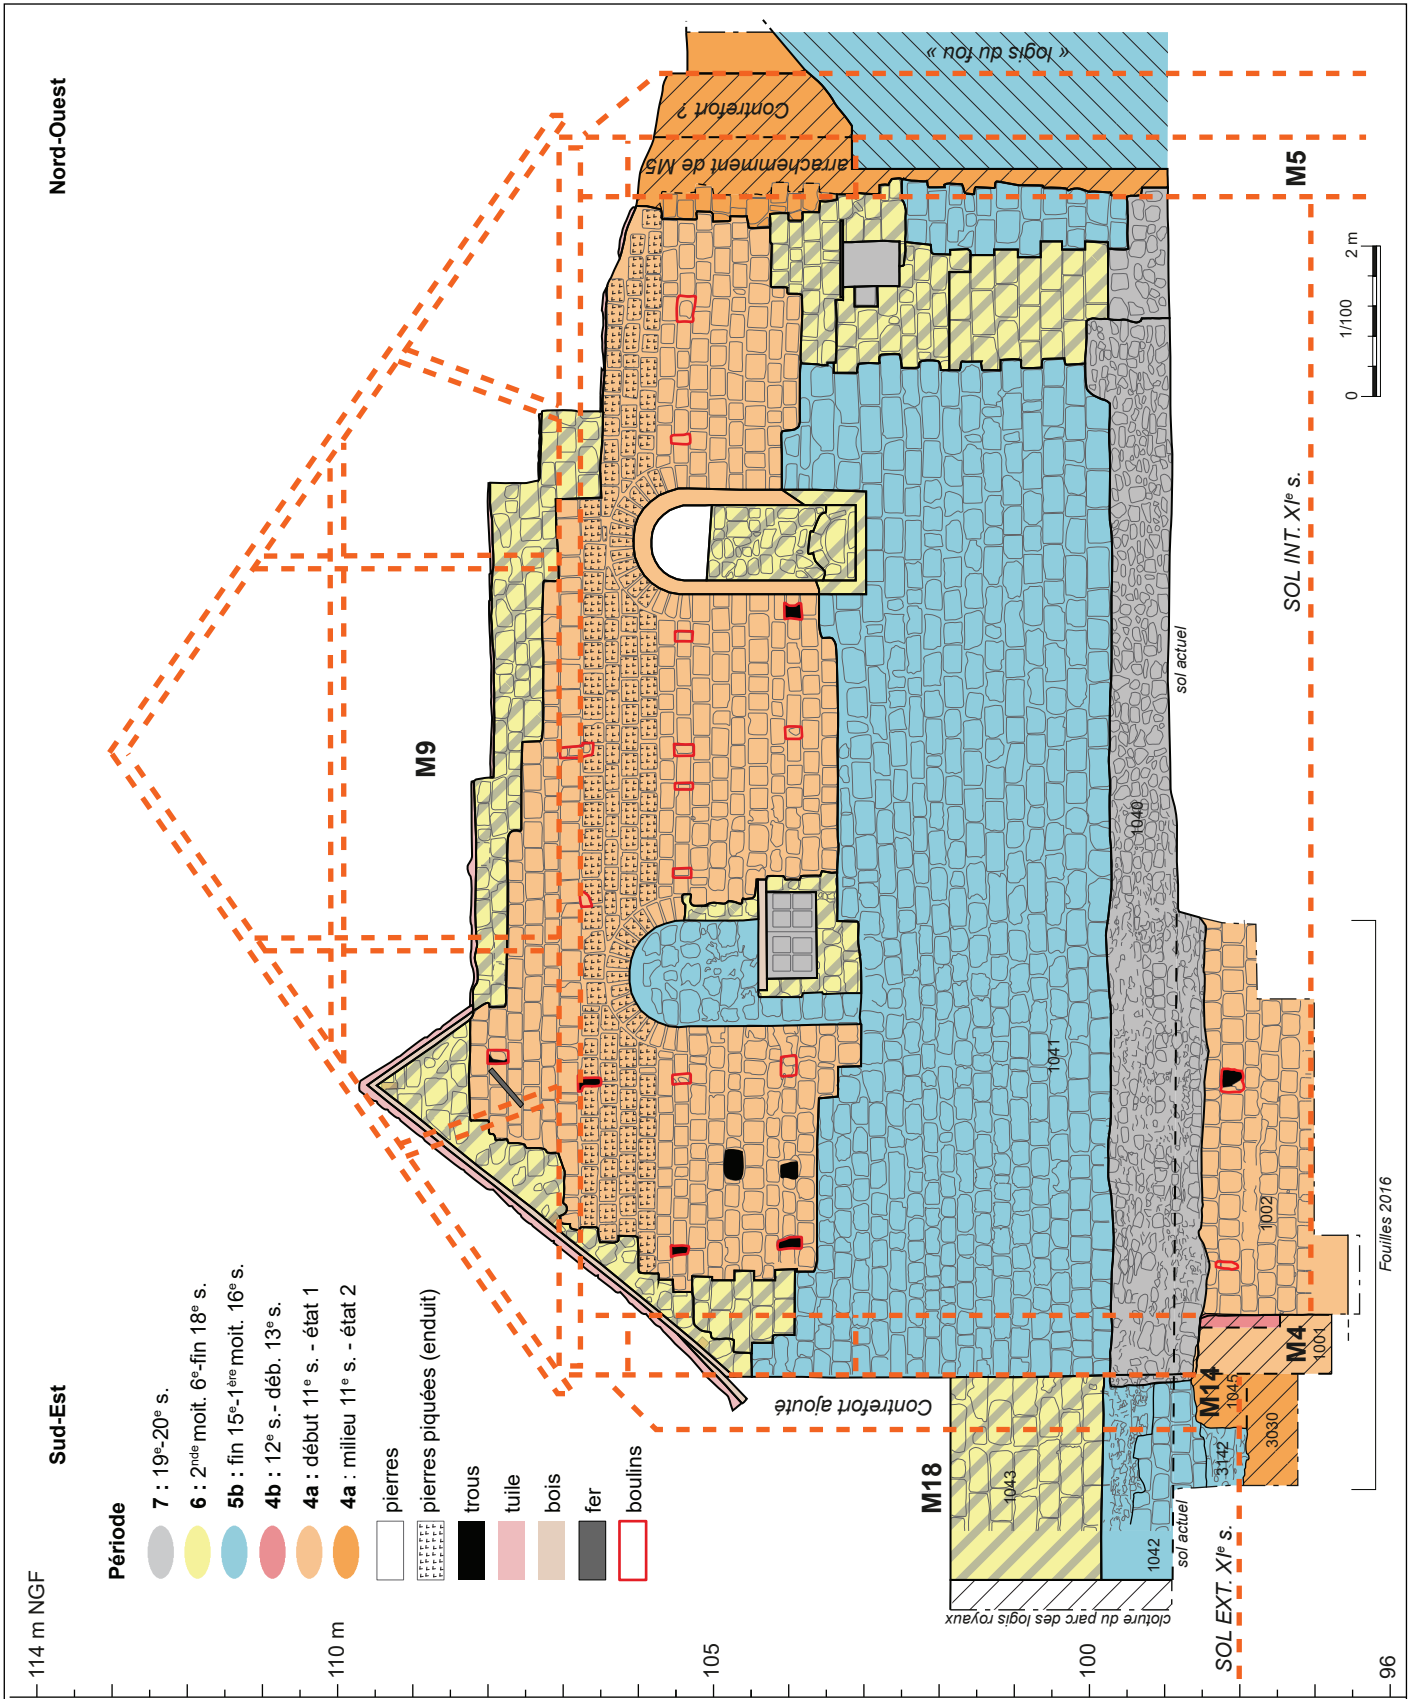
Relevé pierre à pierre du mur M9, avec la restitution de l'élévation du bâtiment
